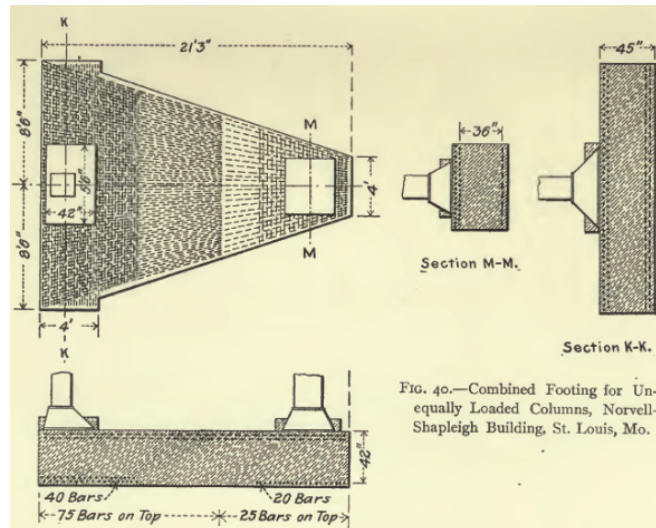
Cimentación mediante zapata combinada trapezoidal. Buel [3].
